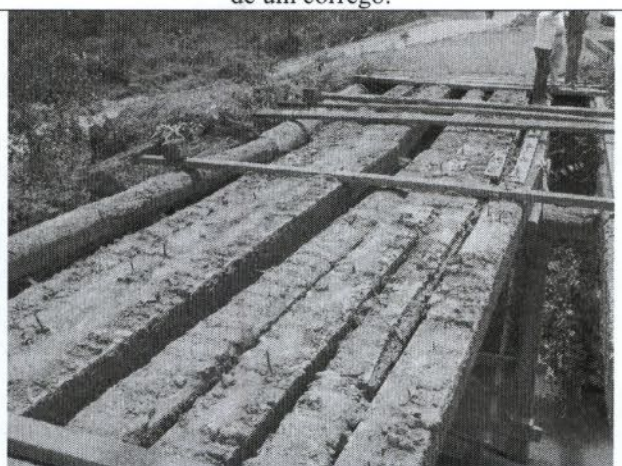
Ponte abandonada obre o rio Belo, onde será construída uma nova ponte
